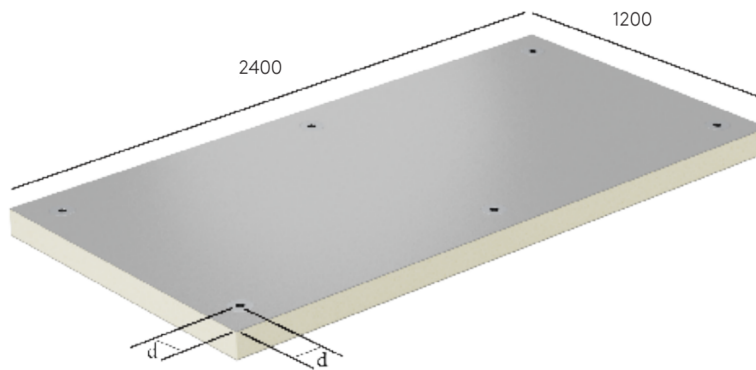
Figura . Planchas 2400 x 1200 mm: 2 fijaciones/m².
